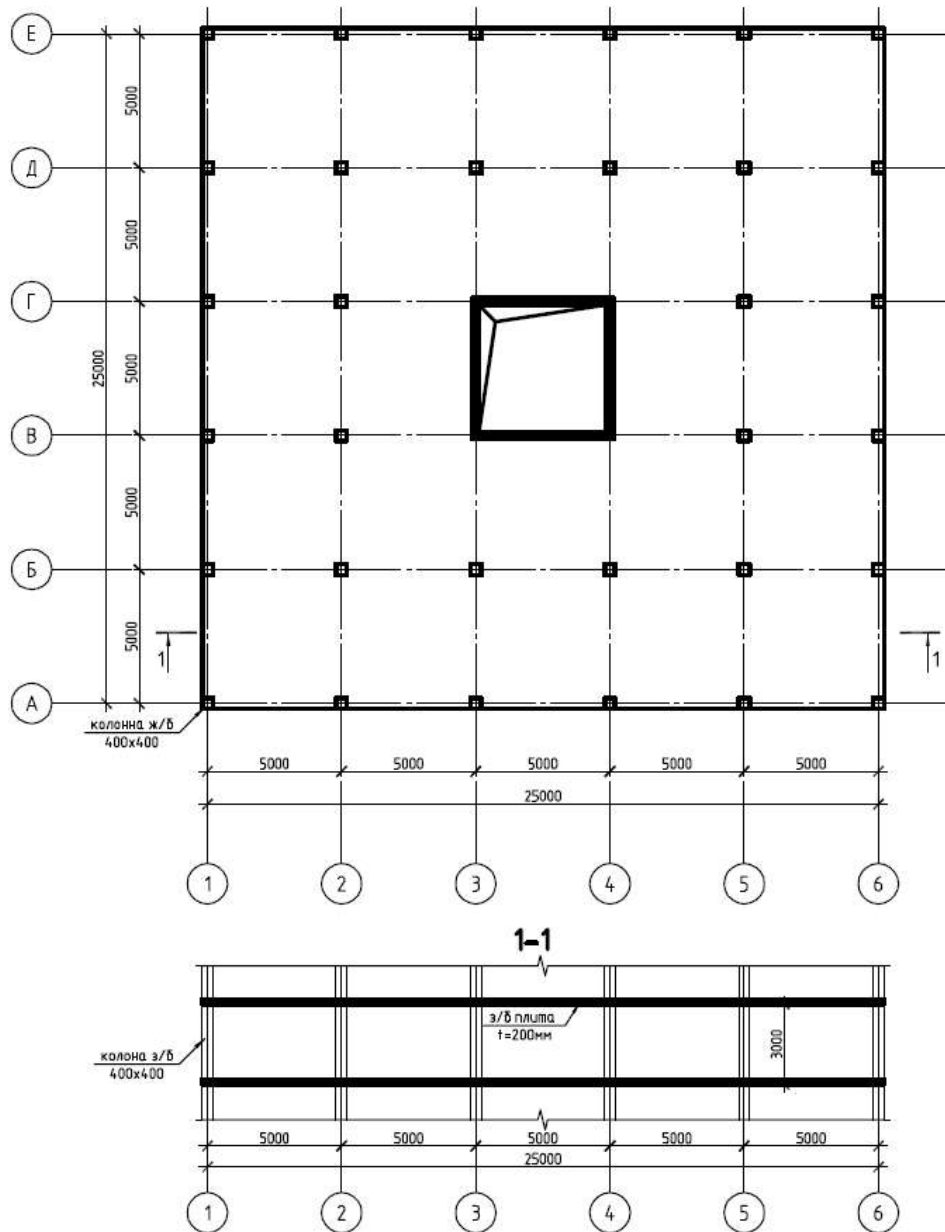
Схема будівлі із залізобетонним каркасом рамної конструктивної системи (варіант 1)
